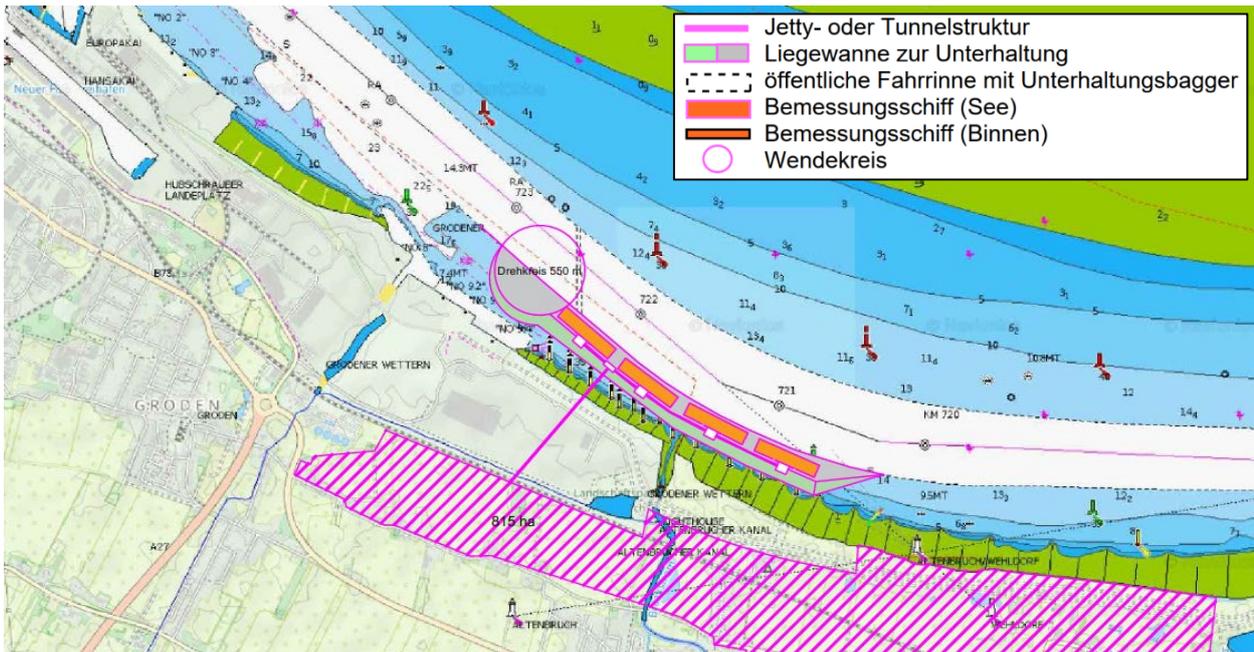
Lageplan Alternative 5: Cuxhaven Groden¹⁷⁹
